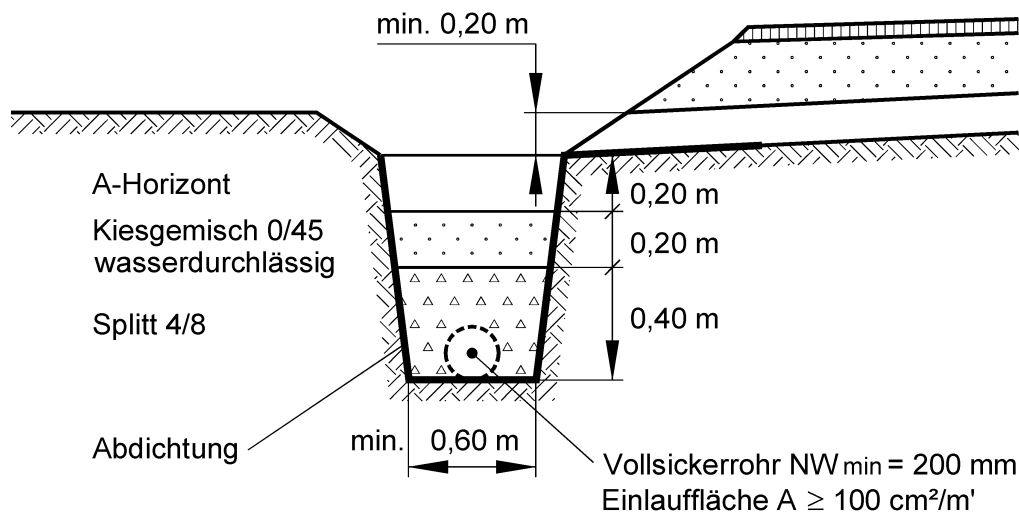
A84 : Drainage de type 2b, tranchée ferroviaire avec surface végétalisée et étanchéité.
